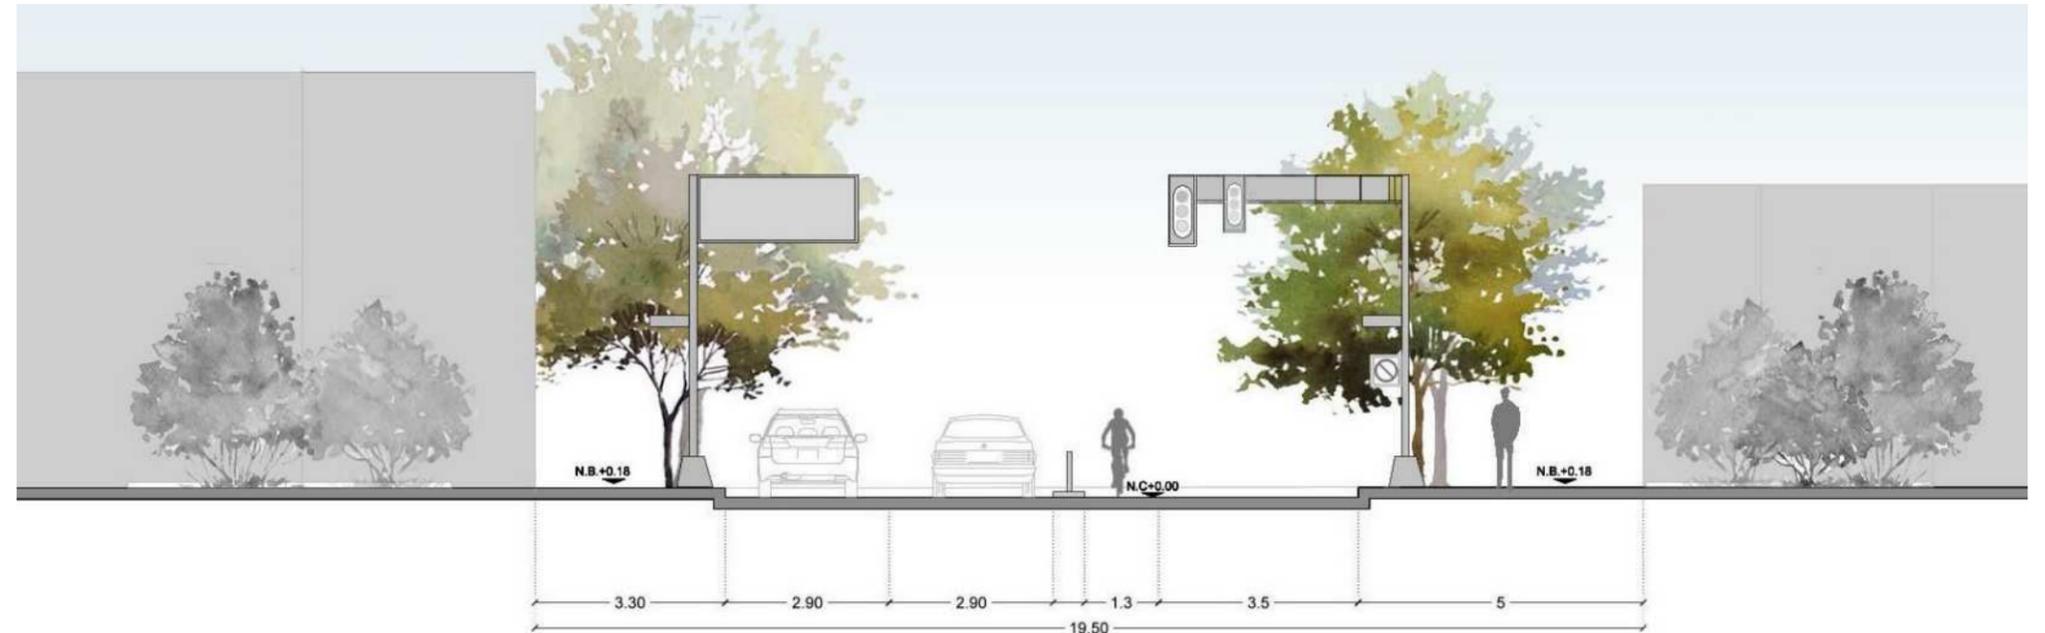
Propuesta de Sección Transversal de Calle Manuel Payno
